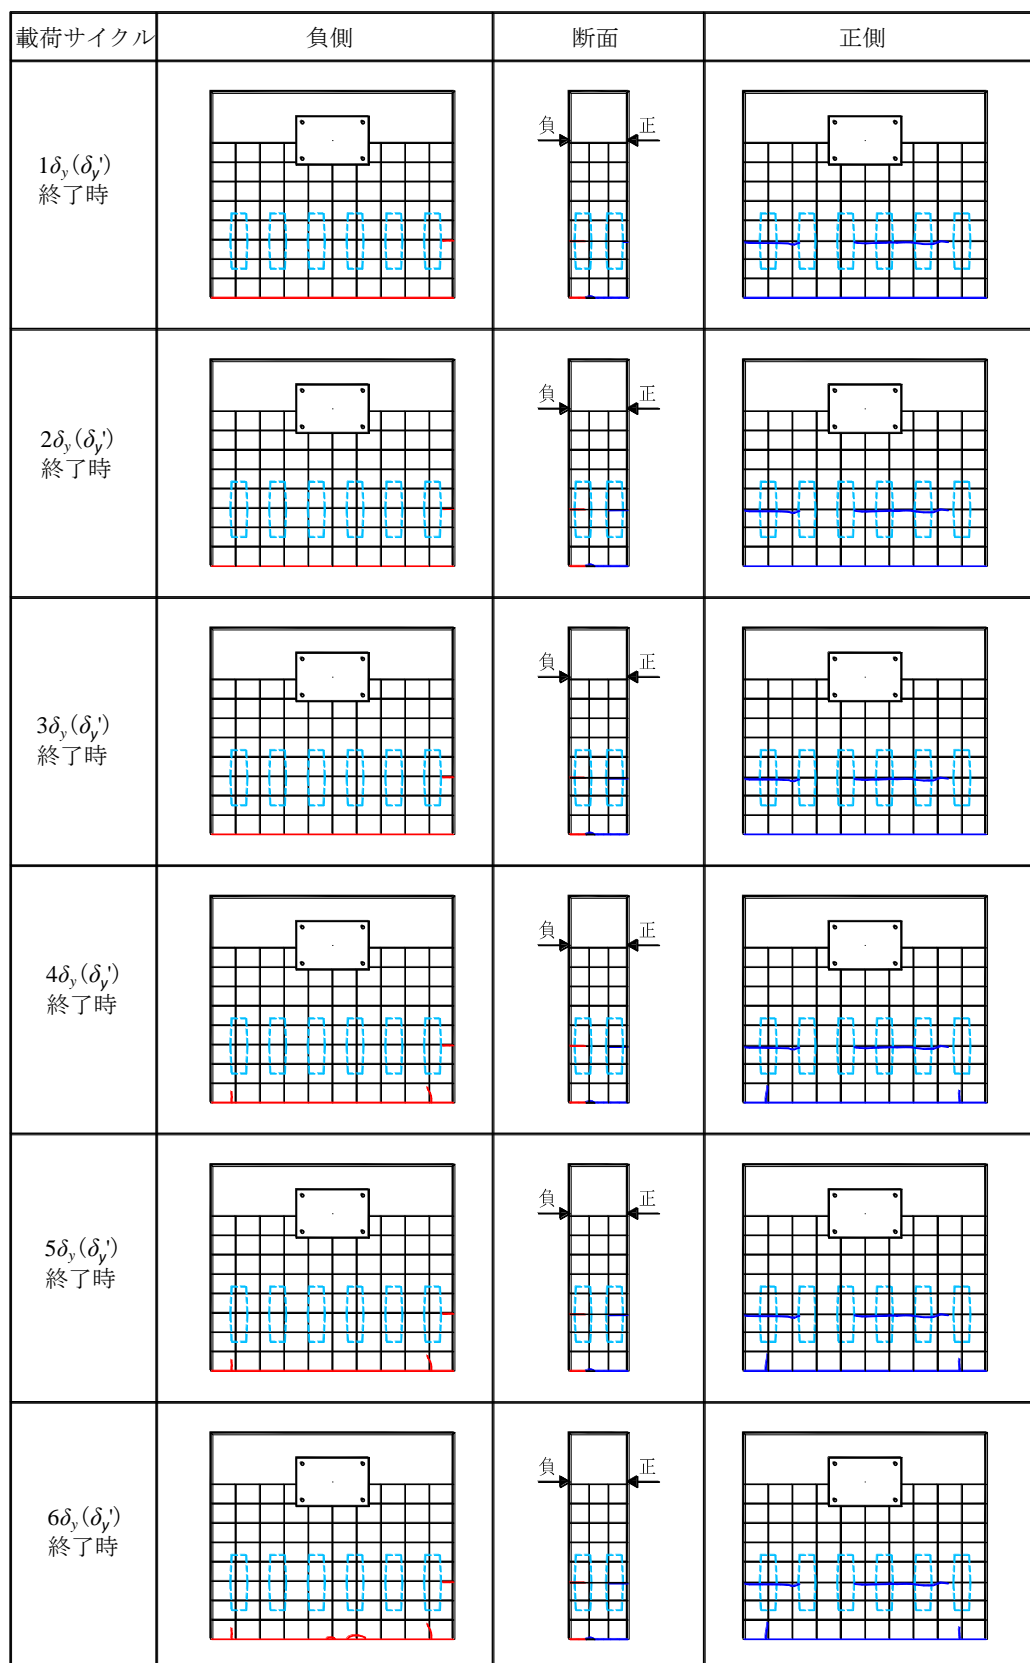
JD13A 試験体ひび割れ図 ($1\delta_y \sim 6\delta_y$)
